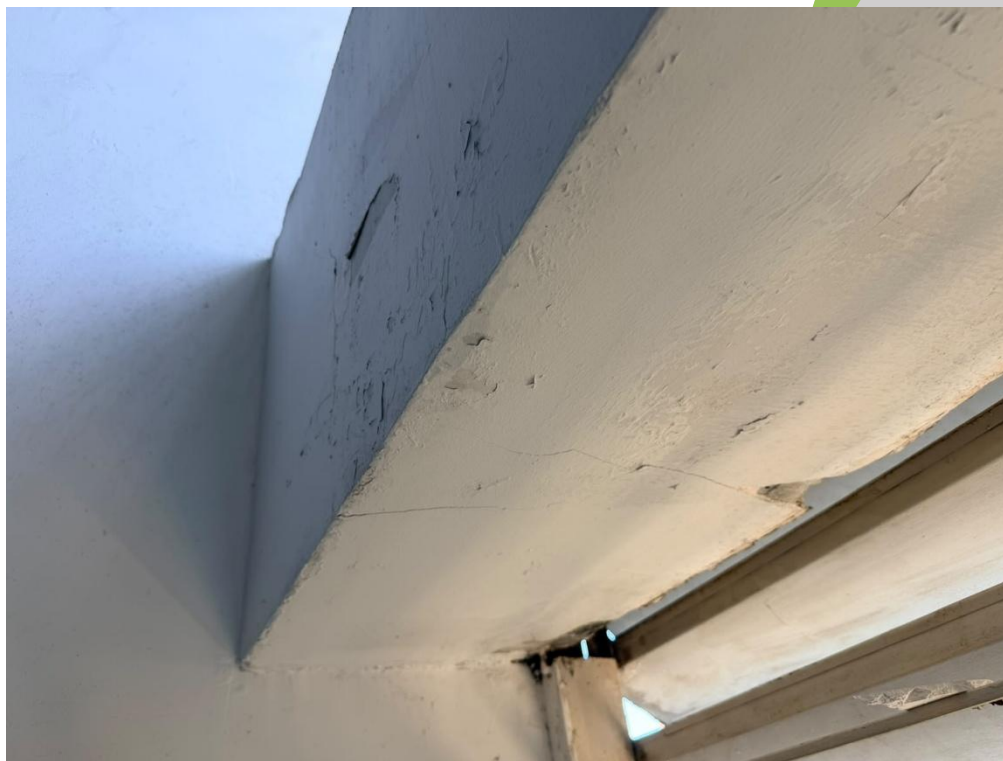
Fisura vertical en viga de 3er piso
